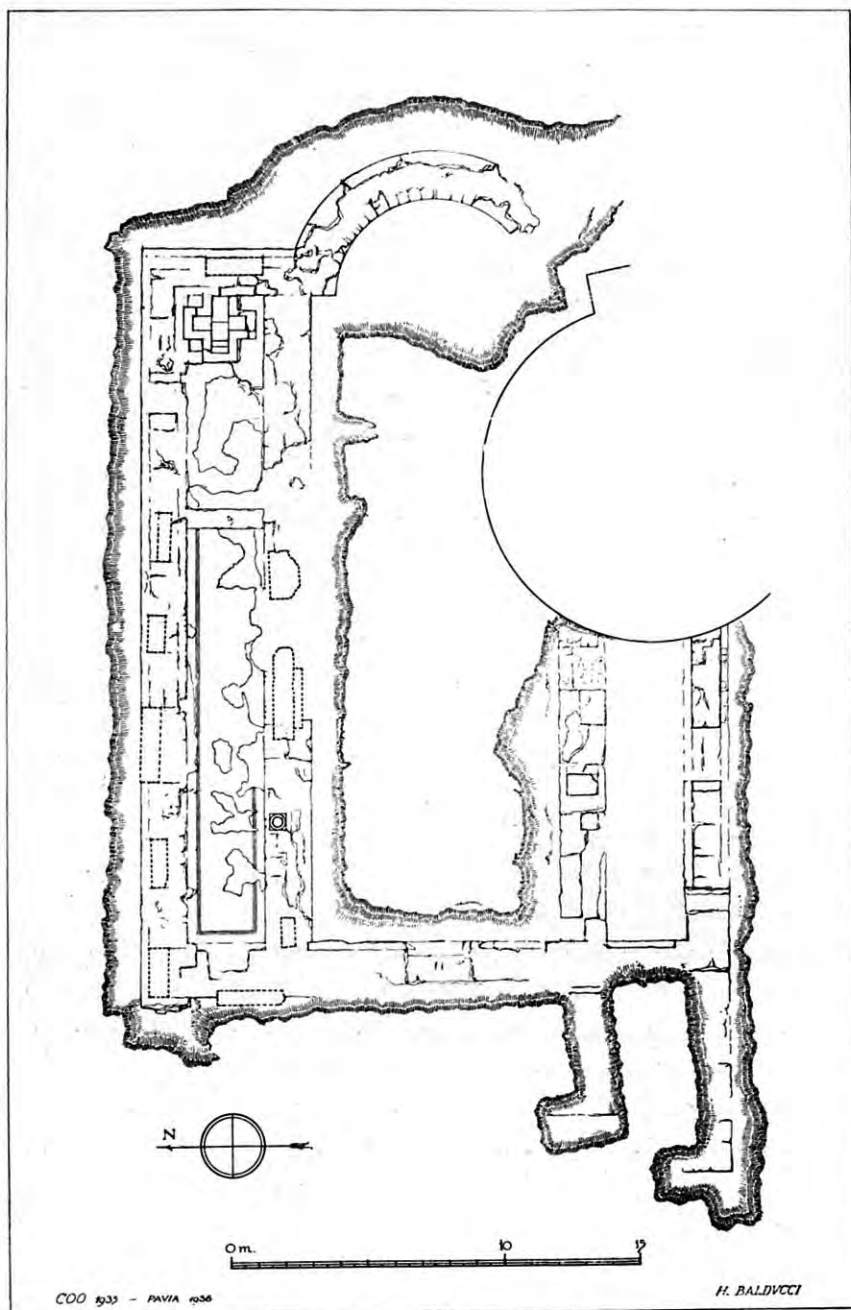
Planimetria della basilica presso Punta della Sabbia.
